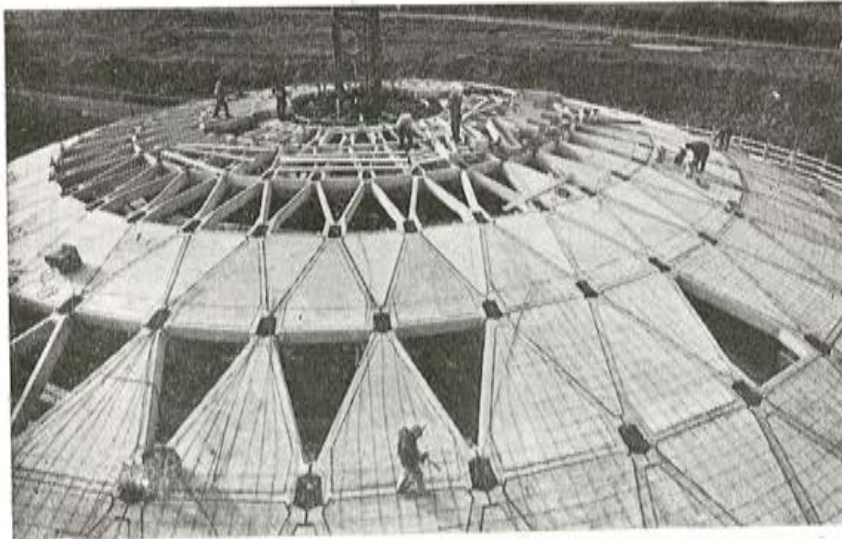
Colocación de la malla metálica antes del recubrimiento definitivo
